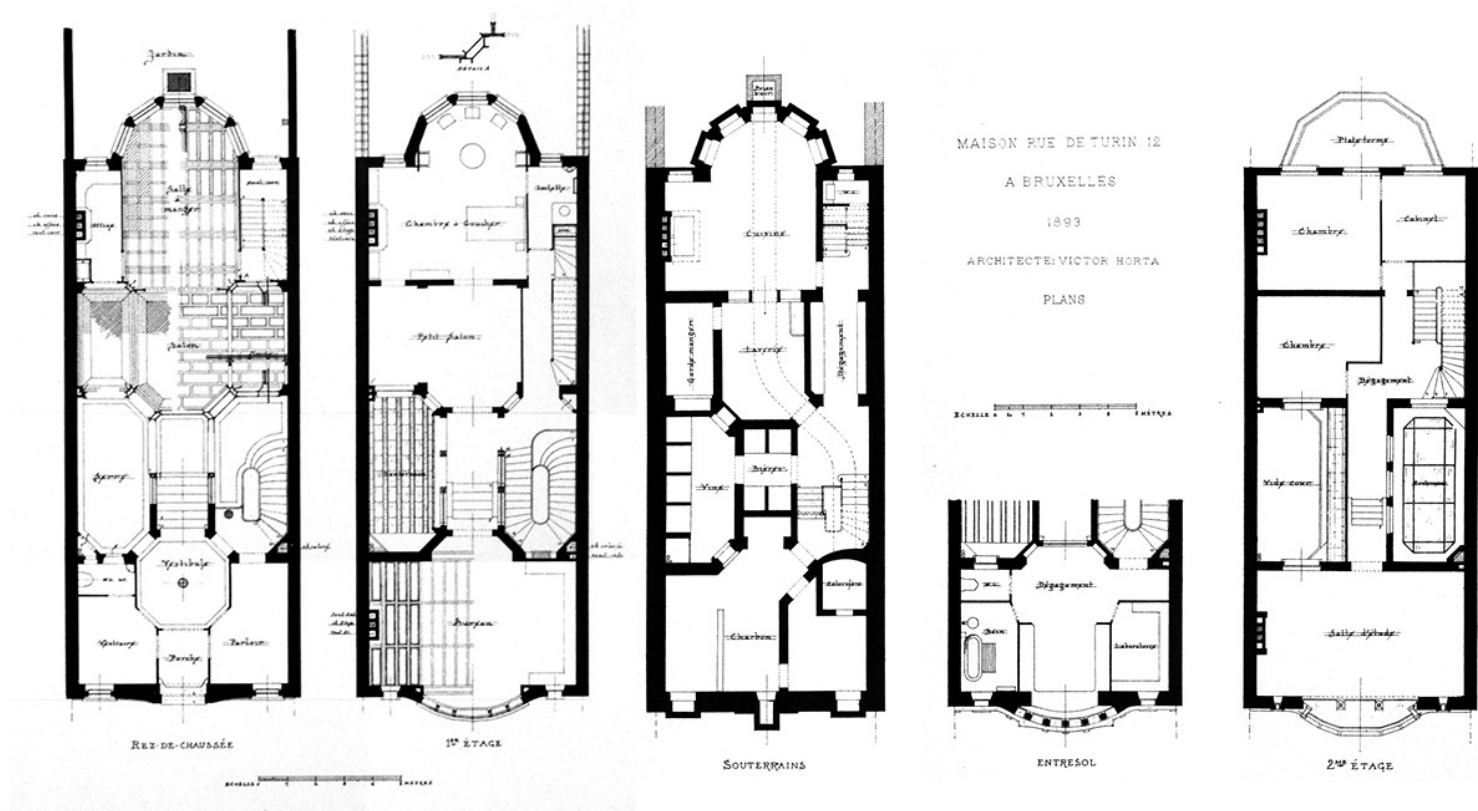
Hôtel Tassel, plans from *L'Émulation*, 1895, plates 39, 40: left to right: main floor, first floor, basement level, mezzanine, second floor [Canadian Centre for Architecture]
